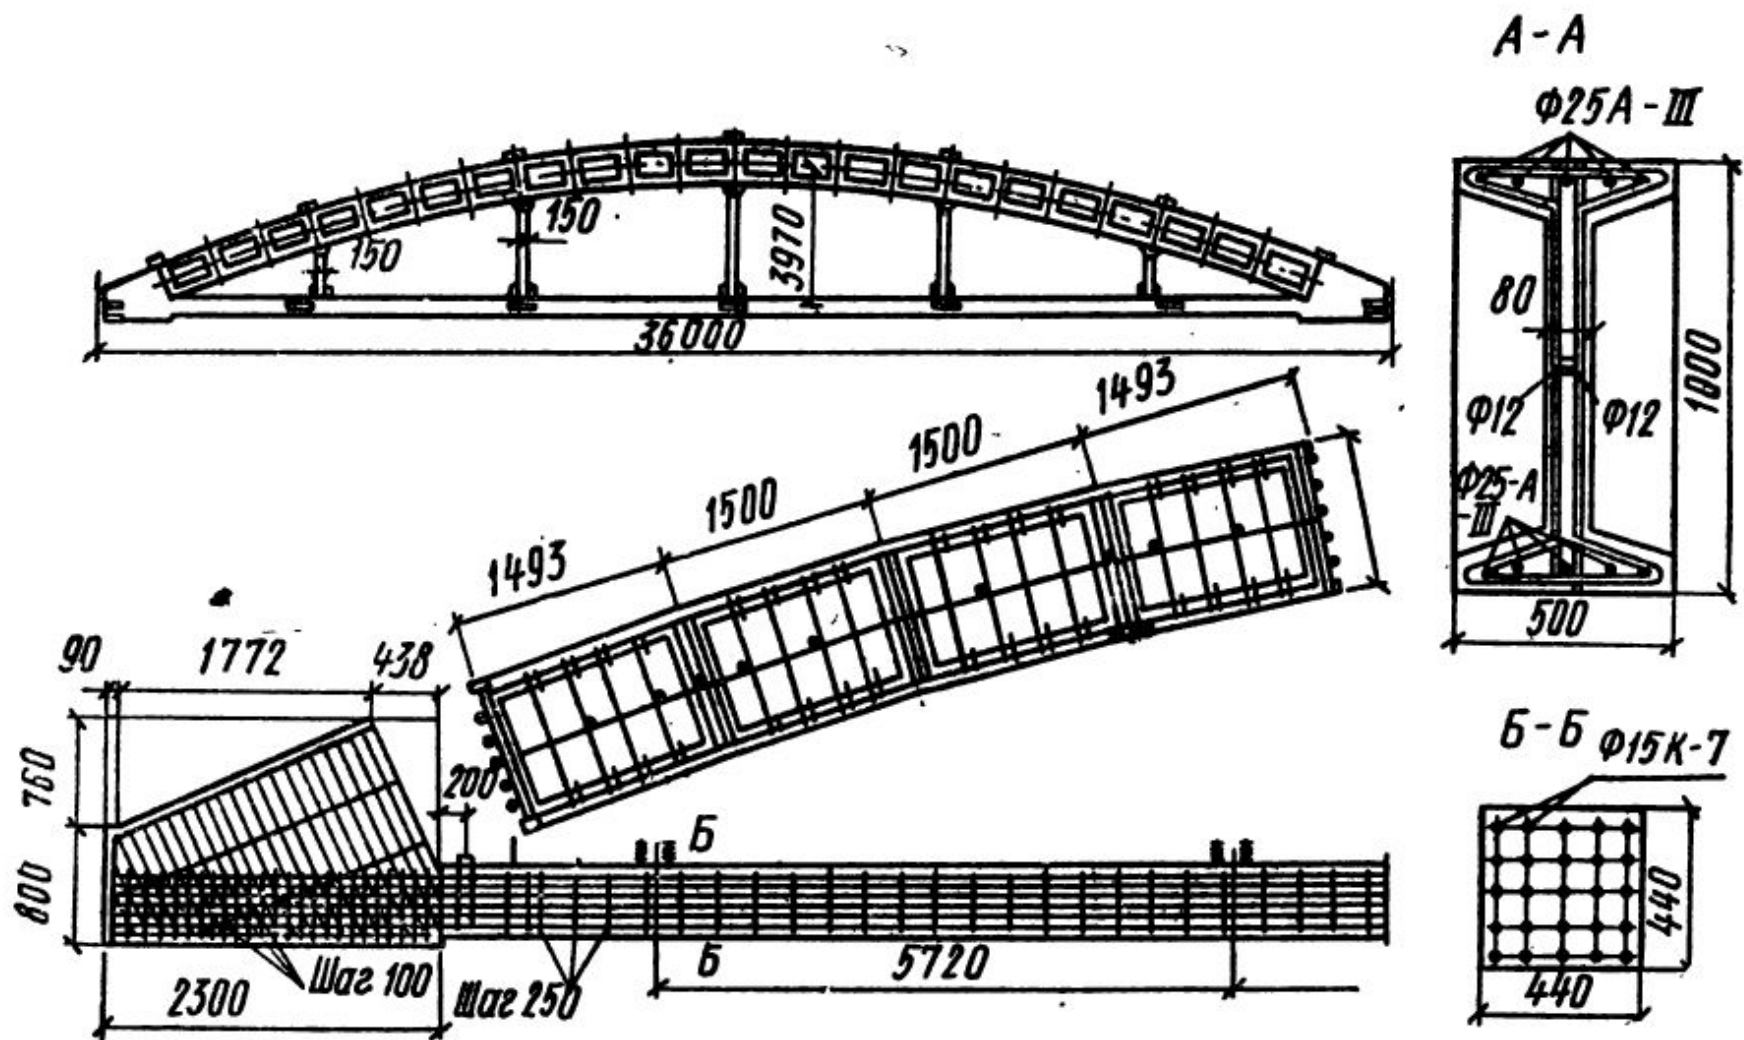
Железобетонная арка двутаврового сечения с затяжкой
